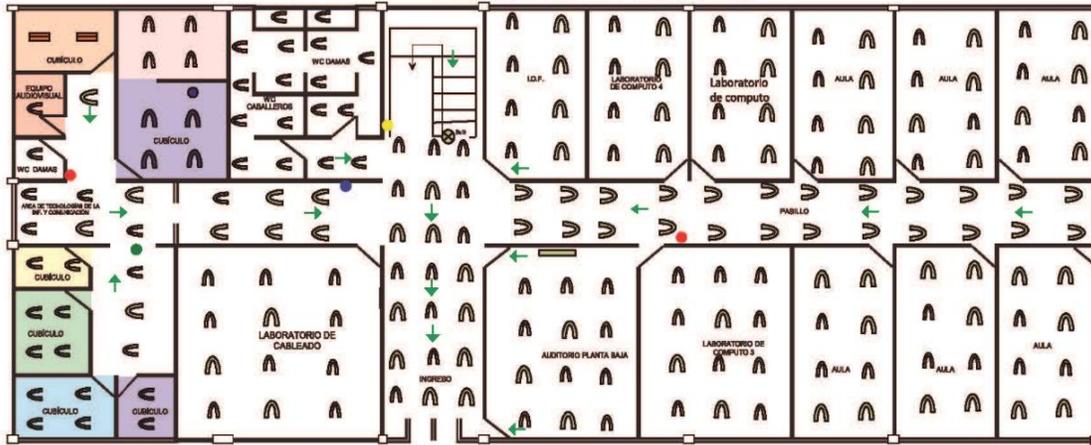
Edificio Docencia “A”, Planta Baja
